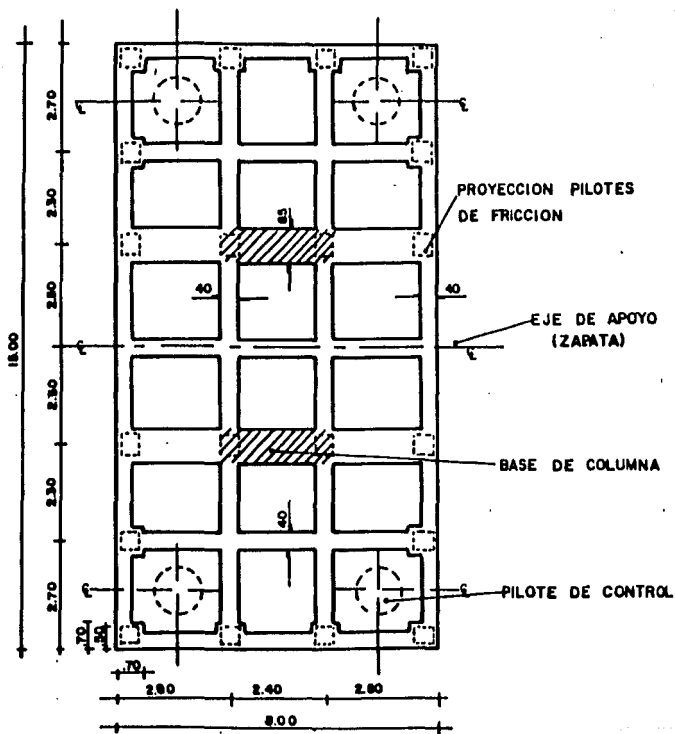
PLANTA DE CIMENTACION DE ZAPATAS TIPO
